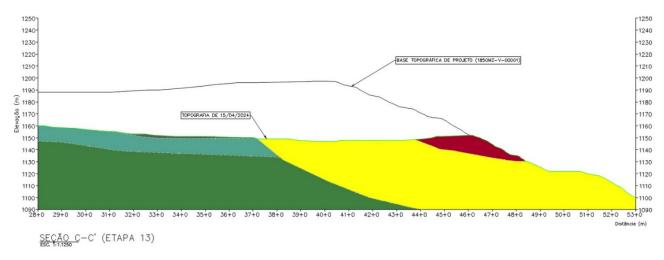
Barragem B3B4 – seção C – Topografia abril/2024 – andamento da etapa 14de escavações.
